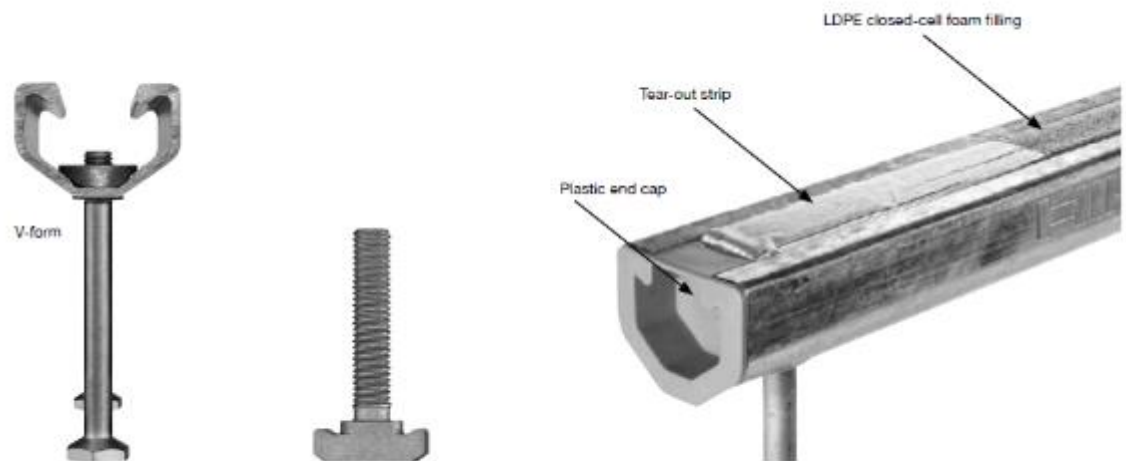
Anclaje HAC-40 91/300 F. Fuente Hilti (2014)
